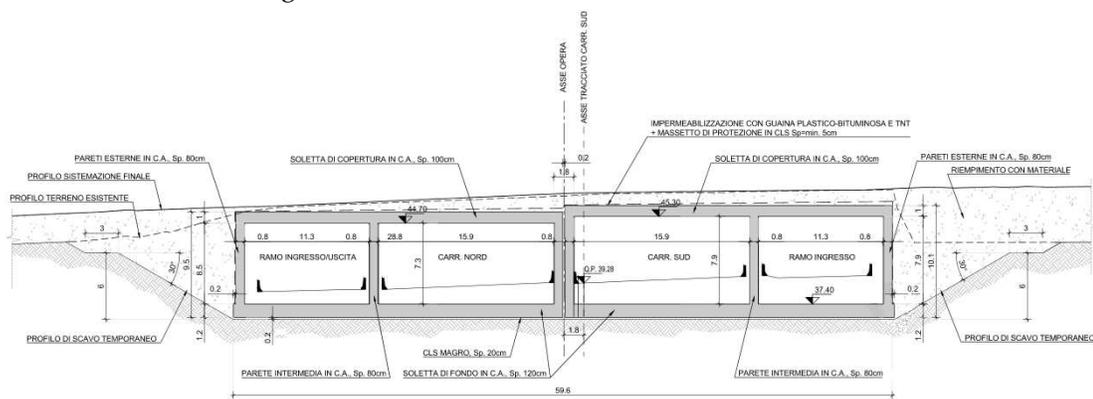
Galleria artificiale GA-02: Sezione trasversale
